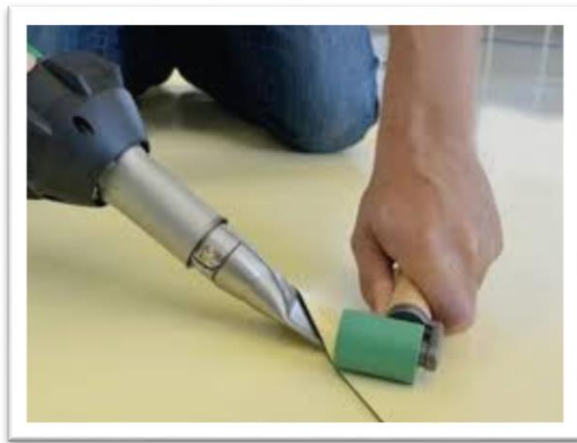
9: Herramienta de soldadura Liester
